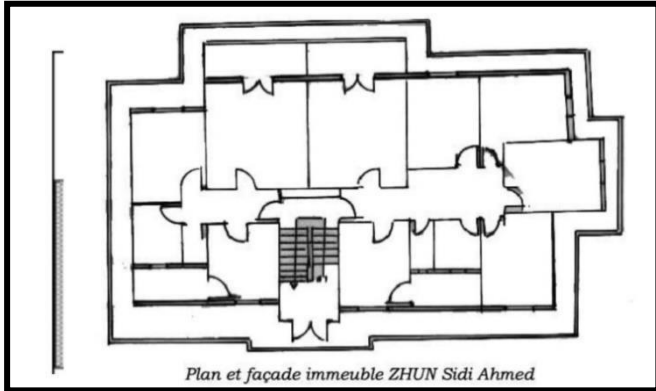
Plan et façade immeuble ZHUN, source : cour HCA (M1 de madame Attar)
